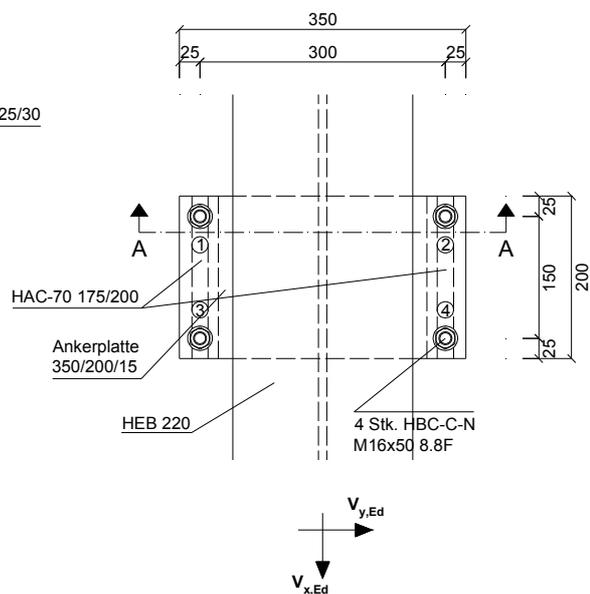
Anschlussdetail K1 Ankerschiene Variante 2 (Maße in mm)
